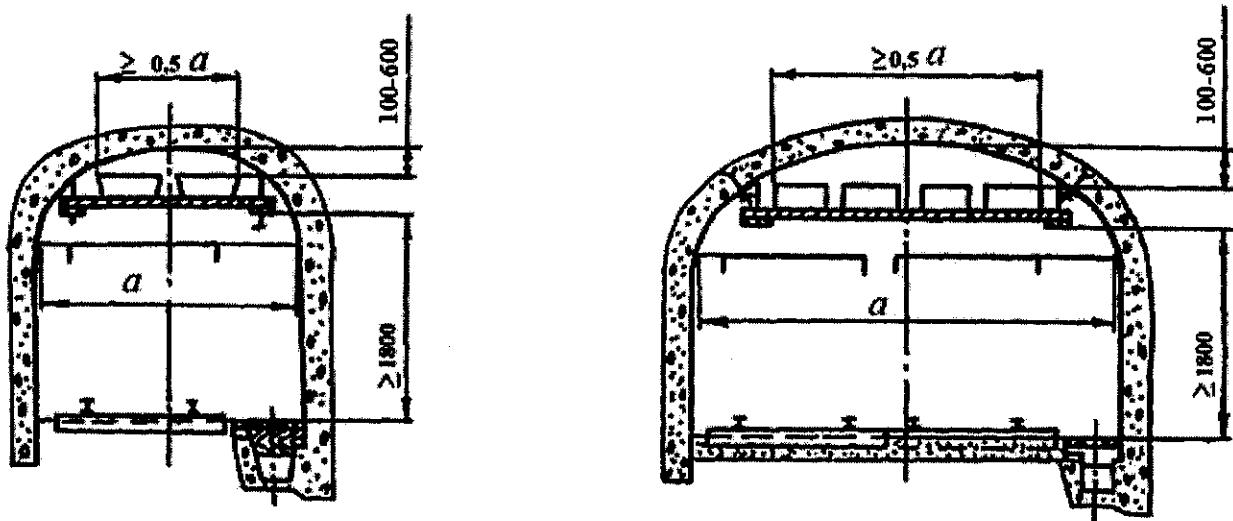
Схема установки водяных заслонов в выработках, закрепленных бетонной крепью
